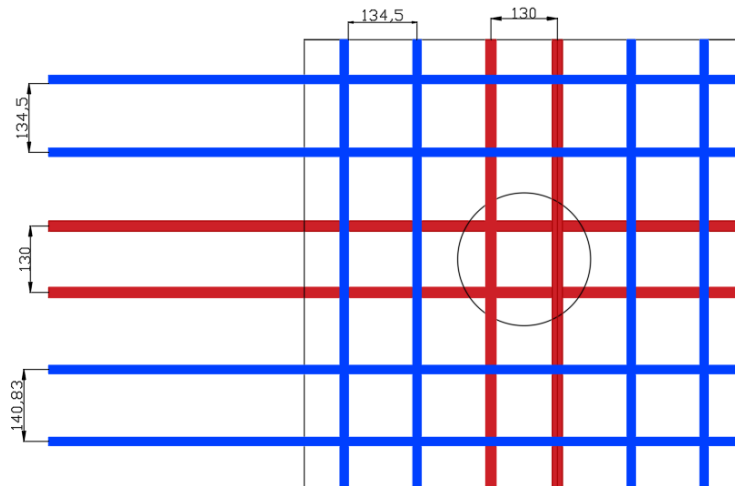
Armadura Estribo 1, Transversal y longitudinal, Espaciado entre las diferentes barras
